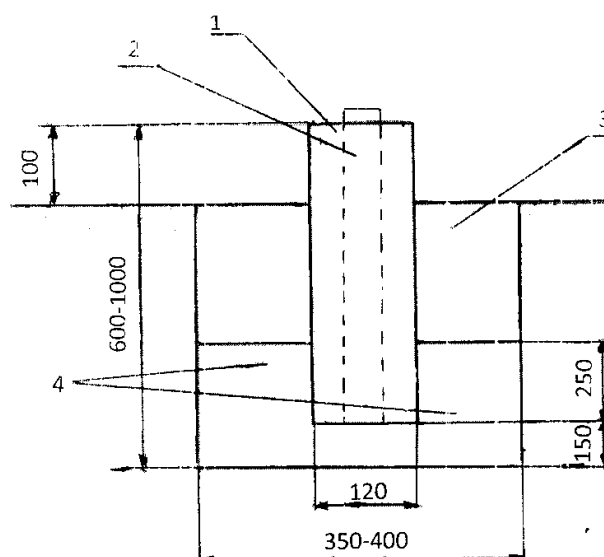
Бетонний фундамент для монтажу аркової плівкової теплиці:
